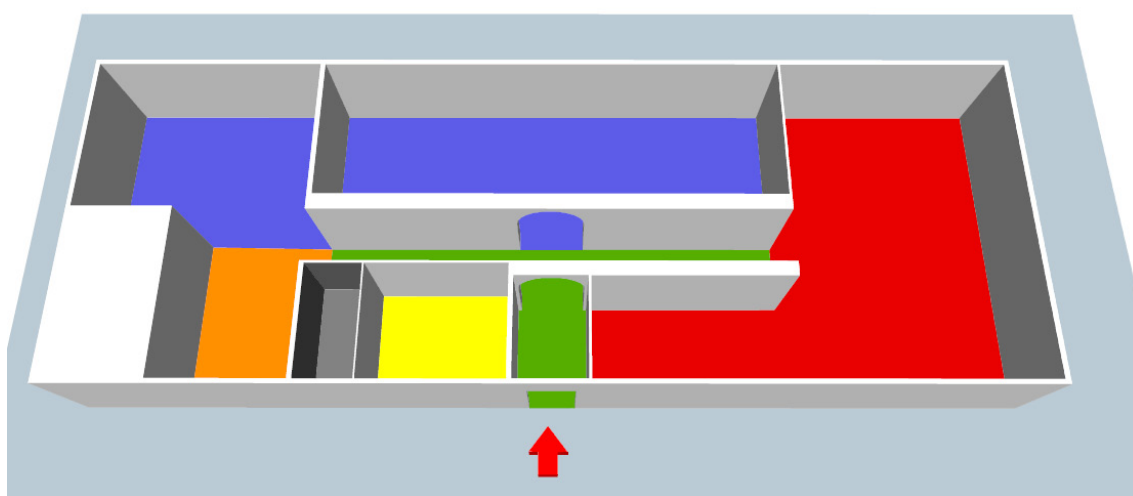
Boceto del edificio del Museo en planta baja. Elaboración propia.
